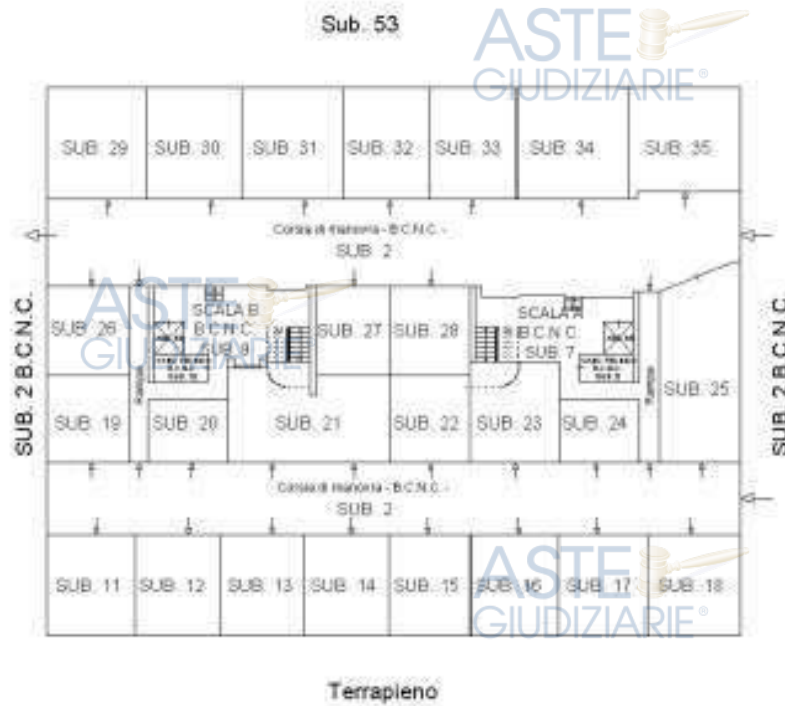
Elaborato planimetrico piano interrato edificio compendio pignorato
